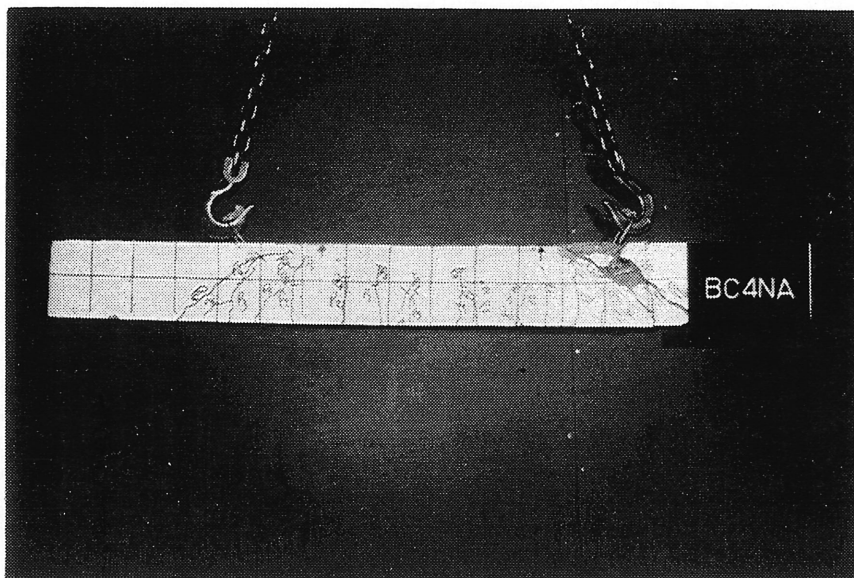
Rupture typique en cisaillement (poutre BC4NA)
